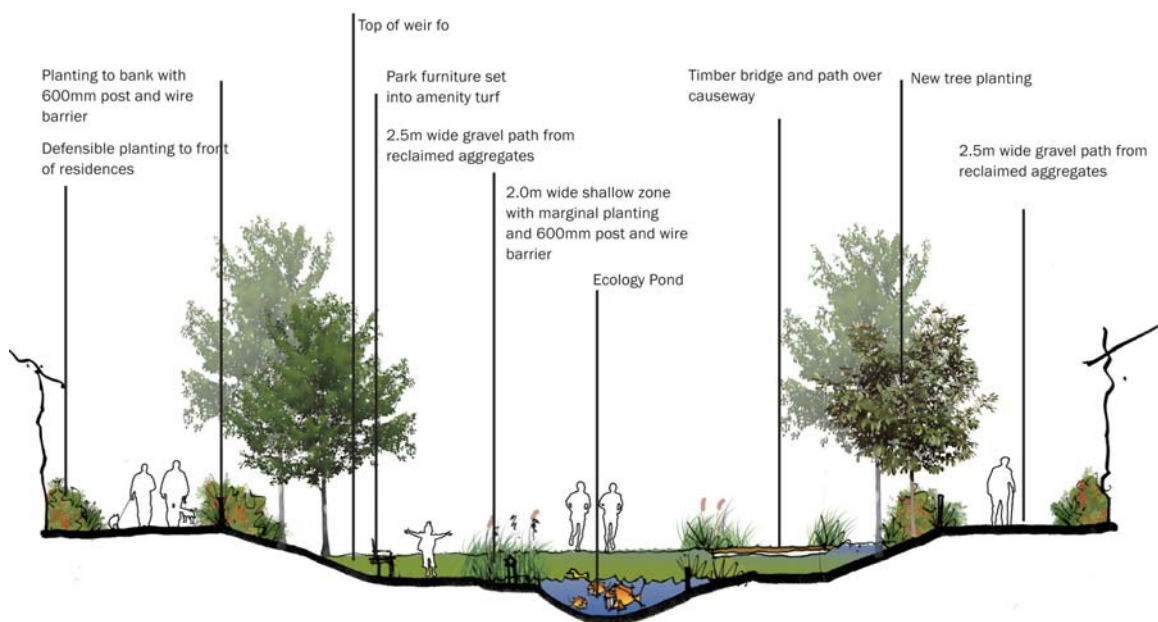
Hanham Hall Eco Village, Bristol, Royaume-Uni, Système de collecte des eaux pluviales (Hanham Hall, Design Statement, 2007)
